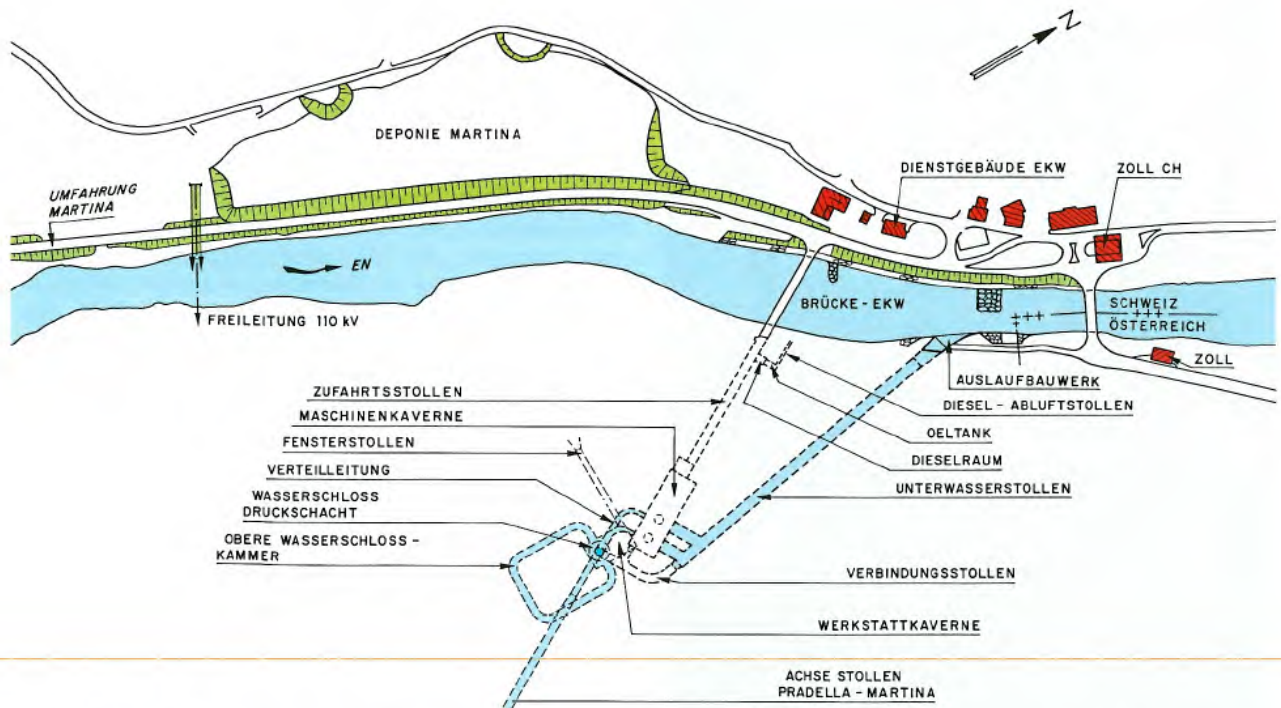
Generelle Disposition der Hauptbauwerke in Martina: Wasserschloss, Kavernenzentrale, Zugangsstollen und Unterwasserstollen mit Auslaufbauwerk.
